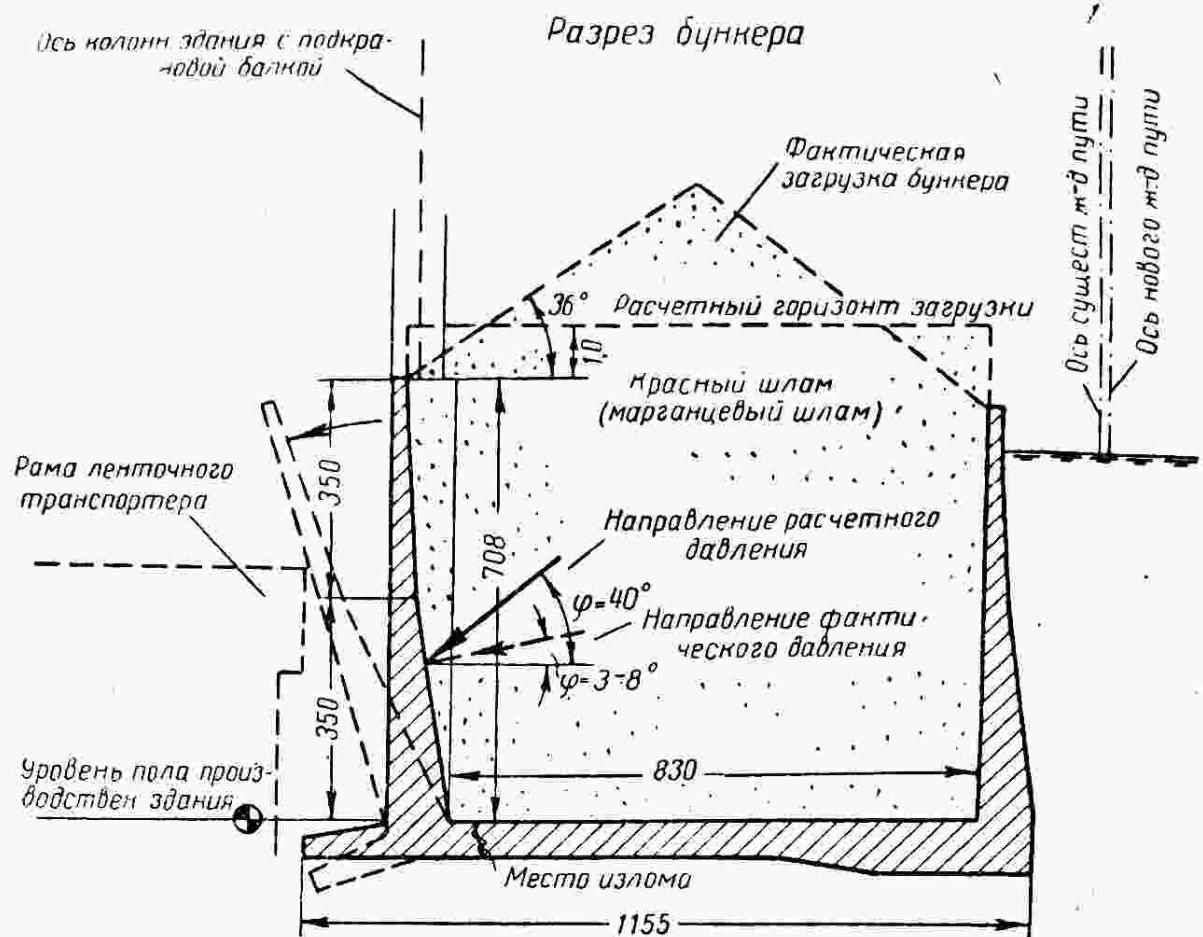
Схема обрушения боковой стенки бункера для хранения рудного шлама
